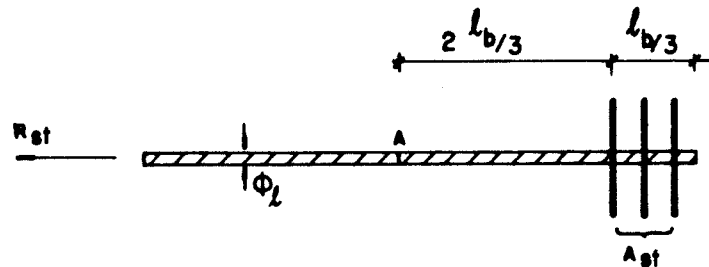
Armadura transversal nas ancoragens - barra tracionada.
